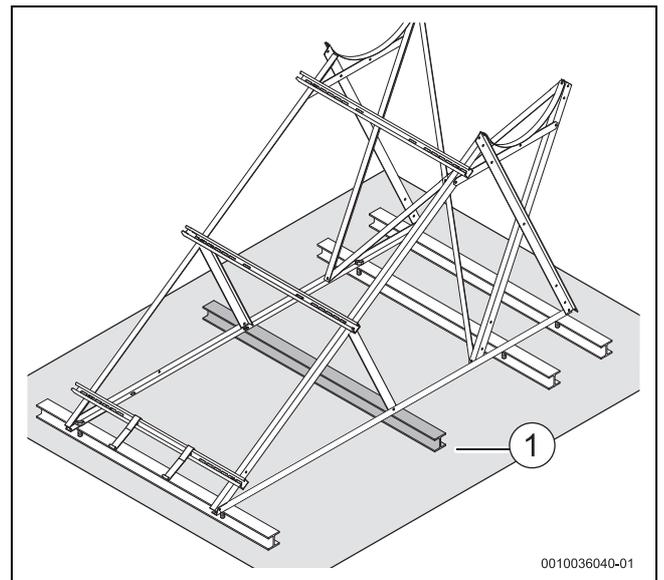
Exemple : raccordement au toit avec plaque de fixation double en T
